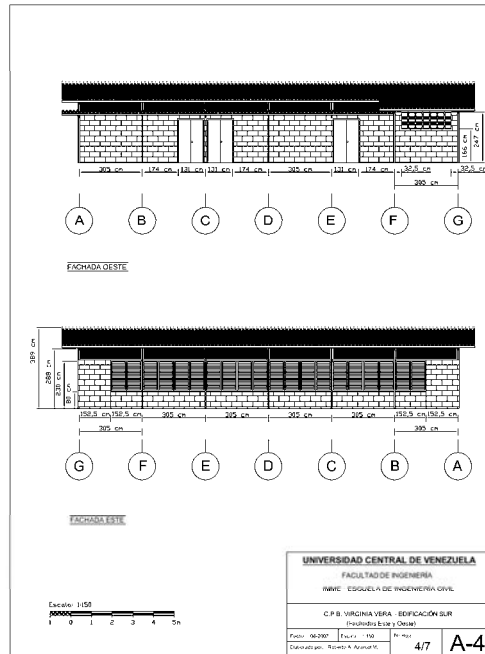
Plano A4: Plano Arquitectónico de la Fachada Este y Oeste
